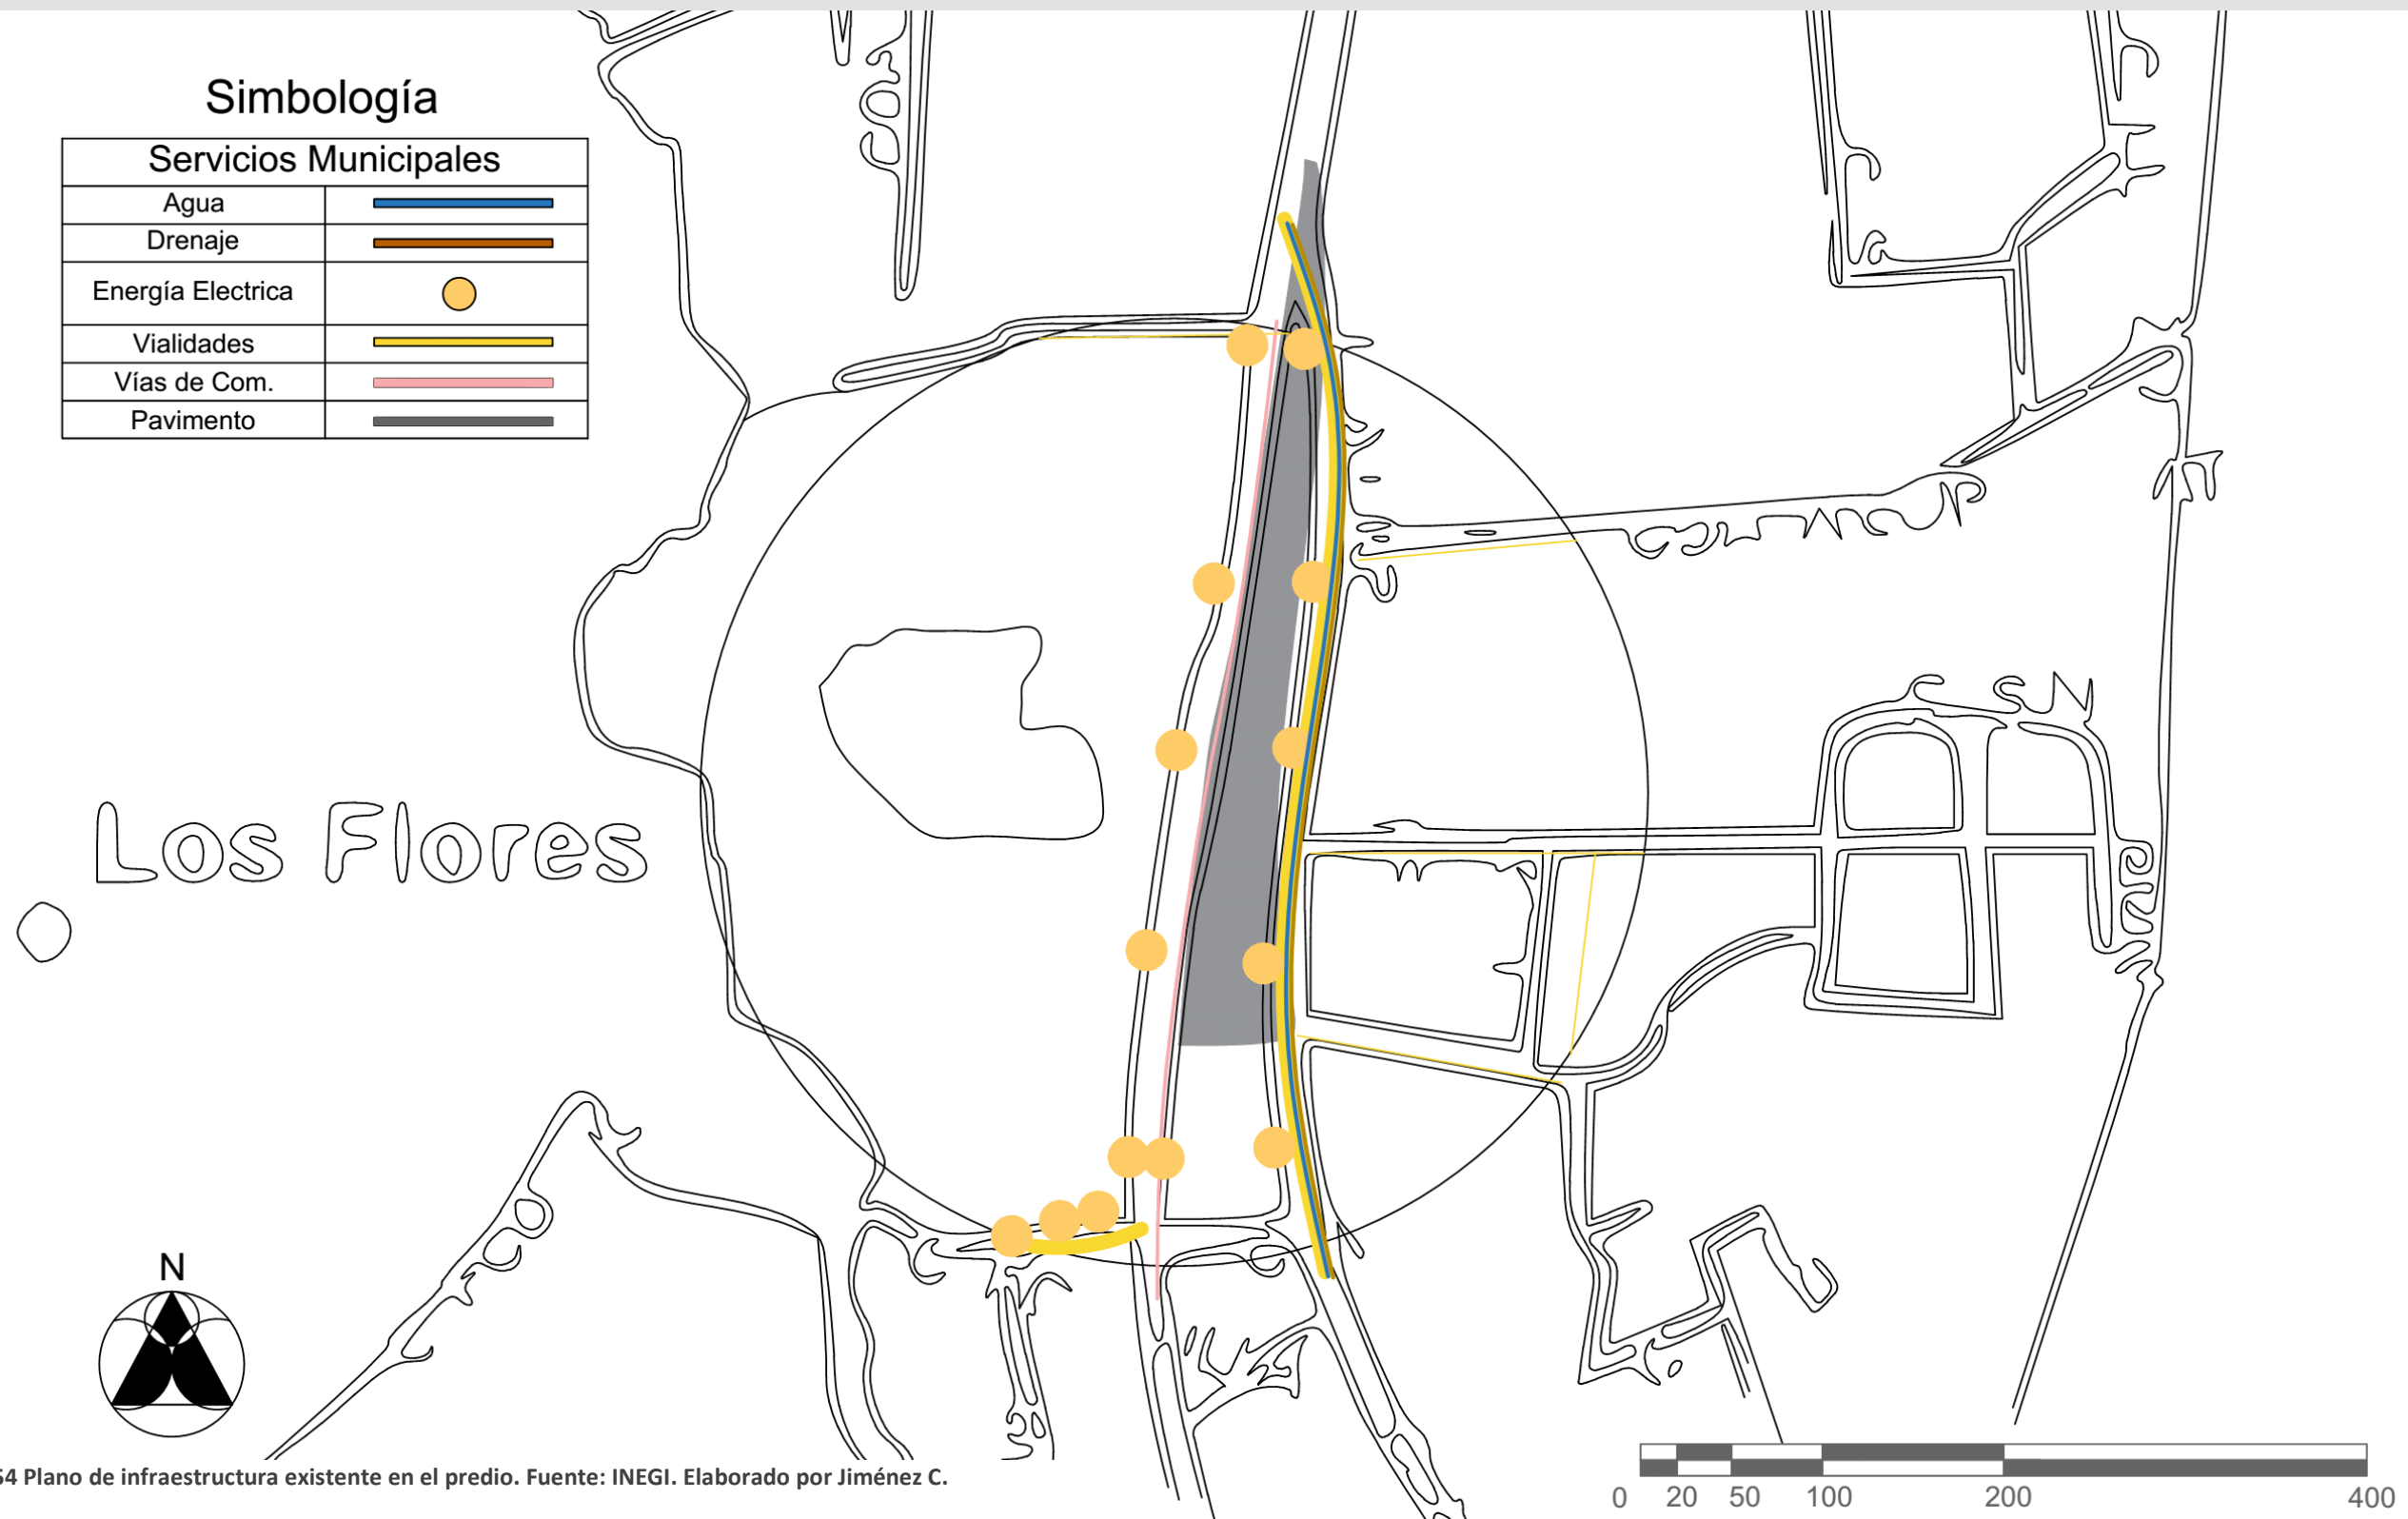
Plano de infraestructura existente en el predio. Fuente: INEGI. Elaborado por Jiménez C.
